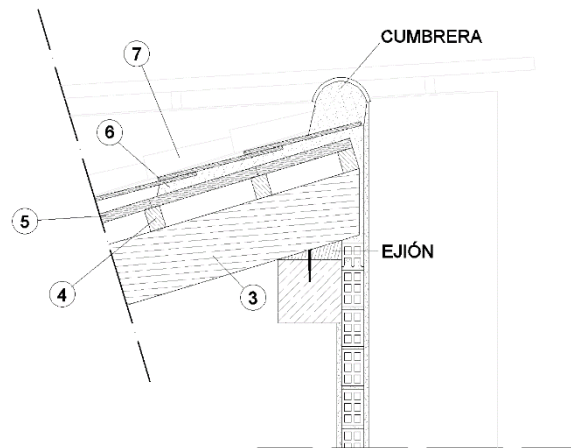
Detalle de cubierta del edificio. Fuente propia.
